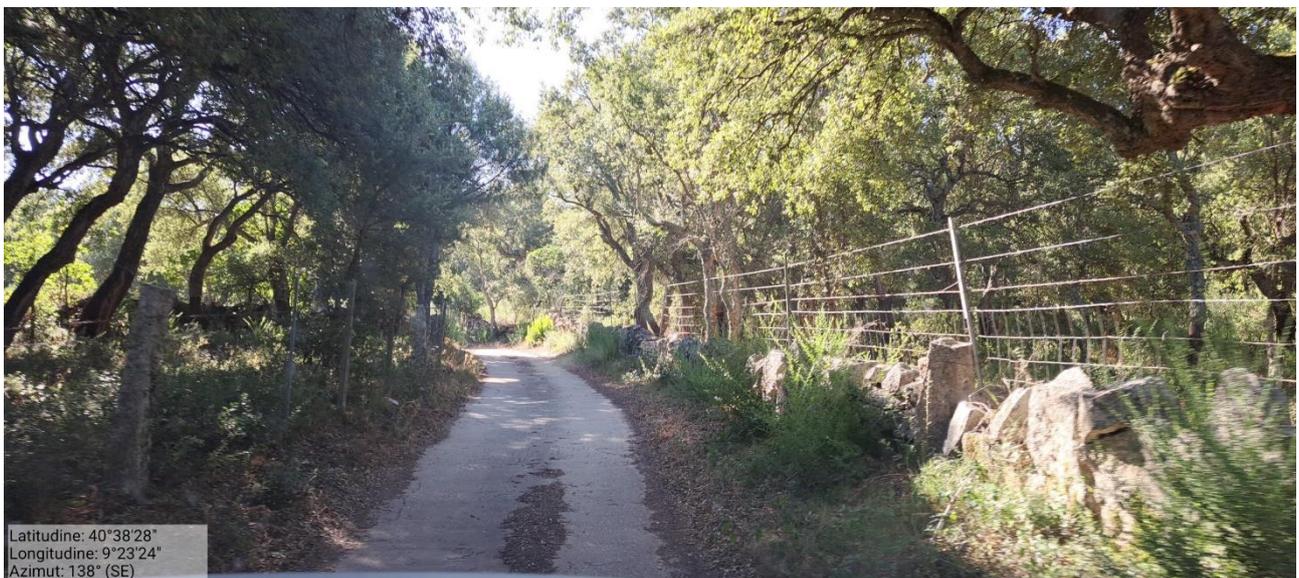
tratto campestre interessato dalla viabilità in progetto di accesso alla postazione eolica T07 (direzione sud-est).
